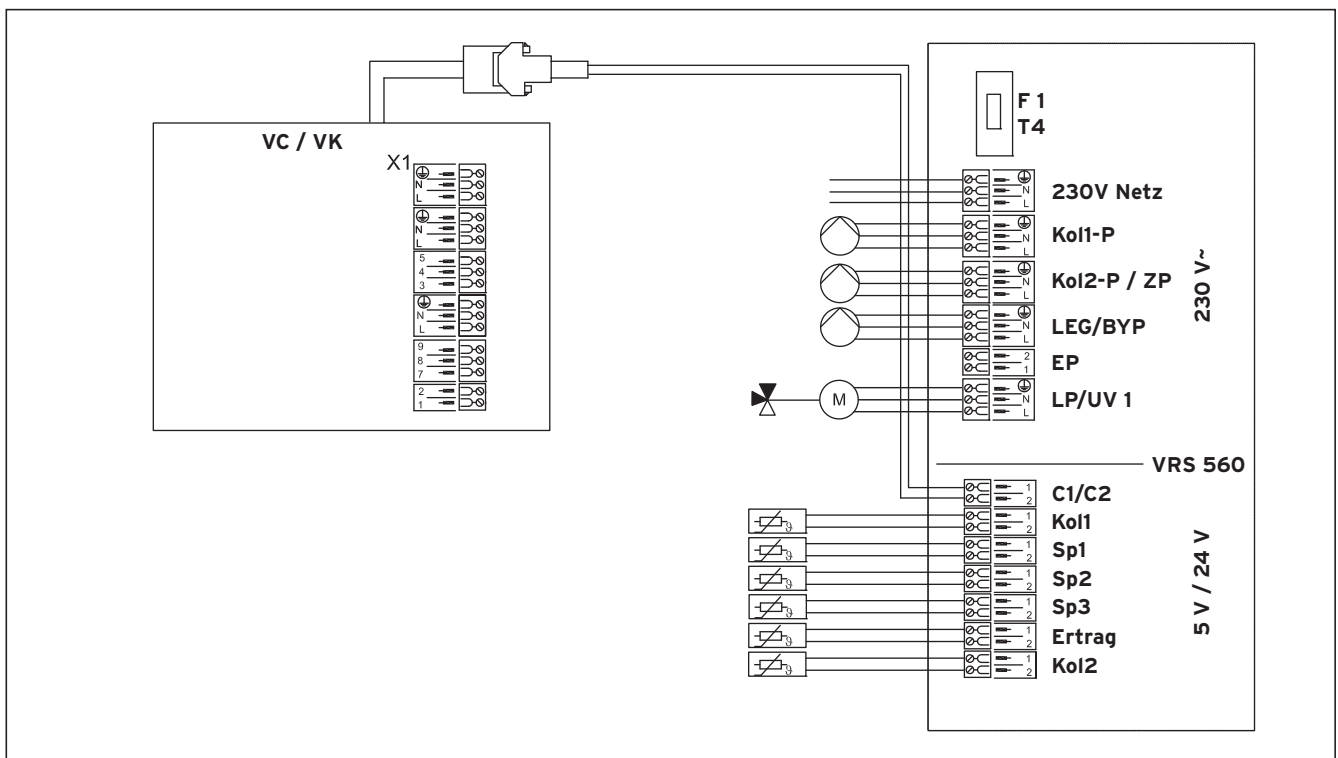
Plan de raccordement pour schéma hydraulique 3:
